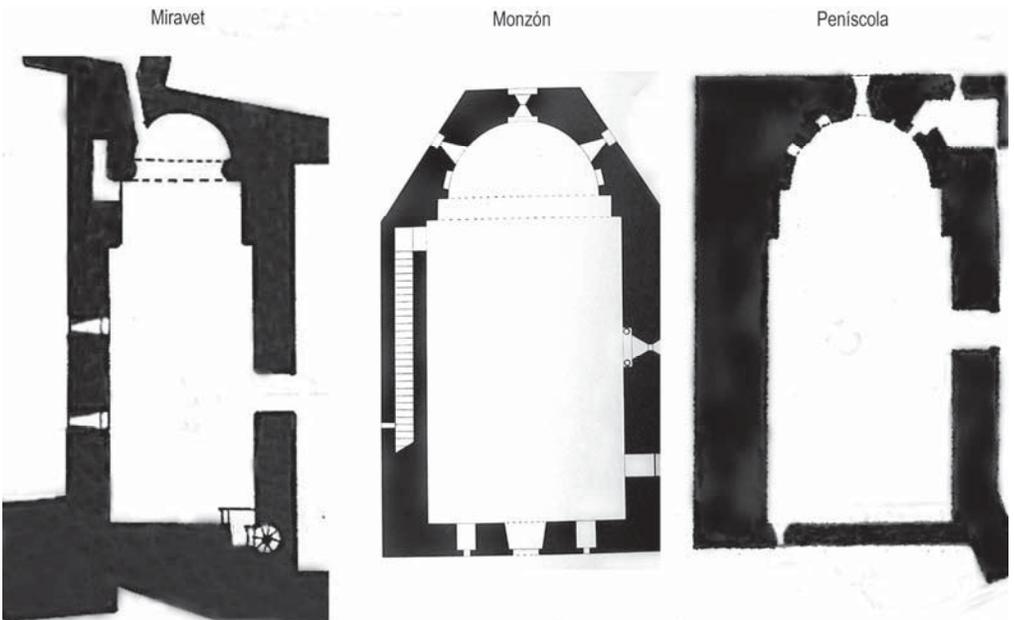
Plantas de los castillos templarios de la Corona de Aragón: planta de Miravet (Ribera d'Ebre, Tarragona), planta de Monzón (Huesca) y planta de Peníscola (Baix Maestrat, Castelló).
